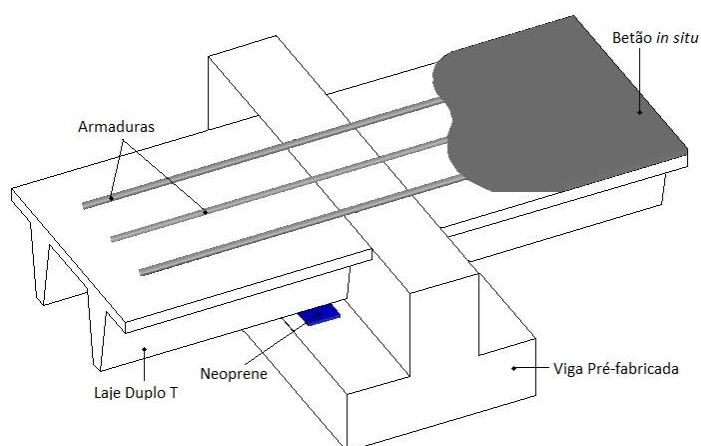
Ligação Laje – Viga central com armadura ordinária
